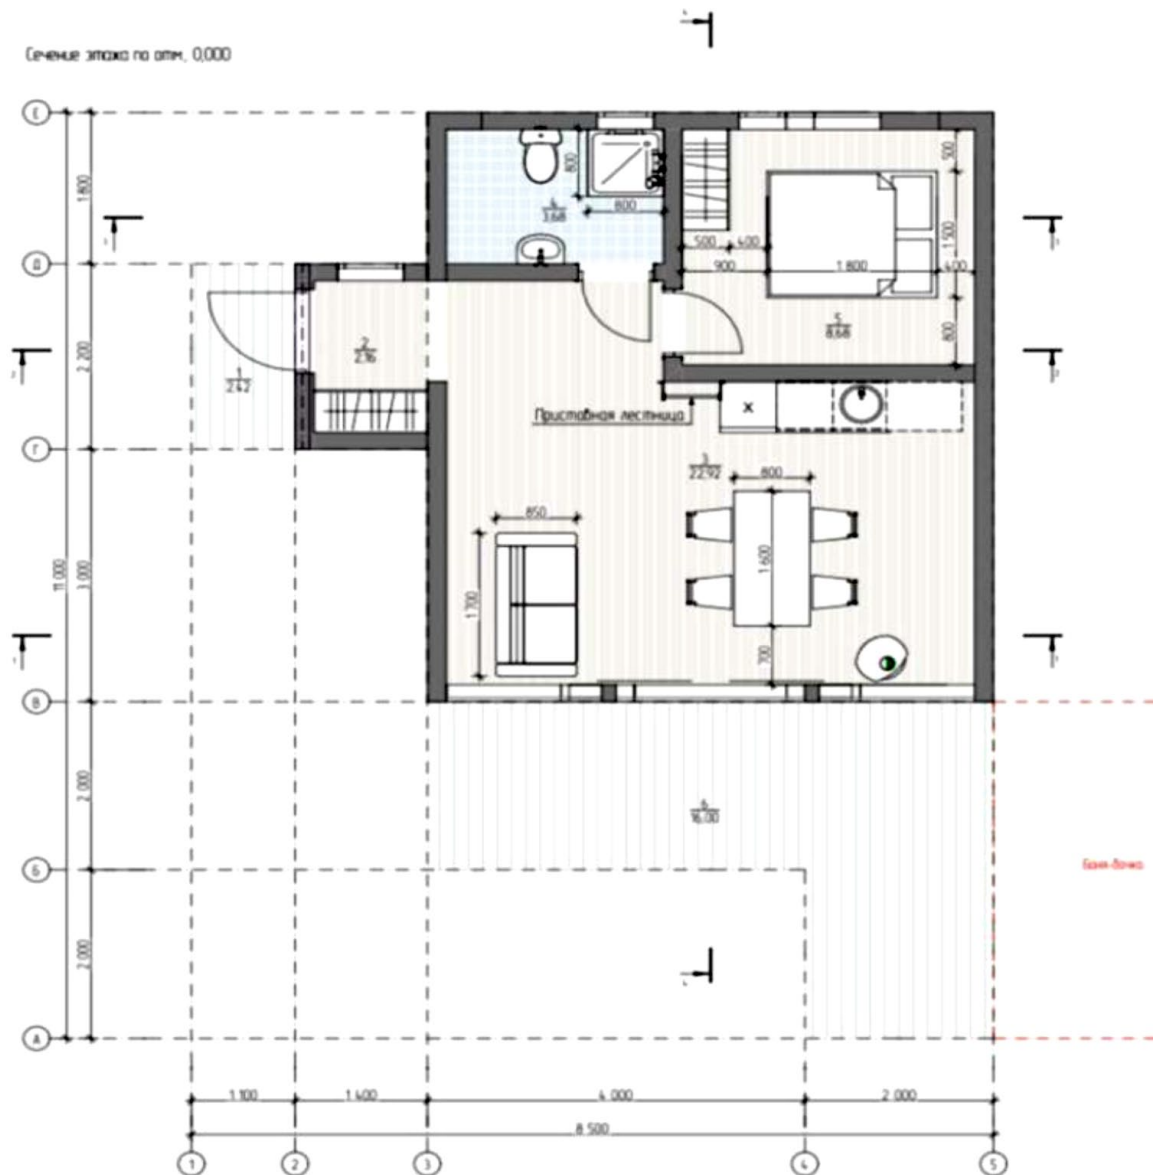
Габаритне креслення планування каркасної будівлі.
